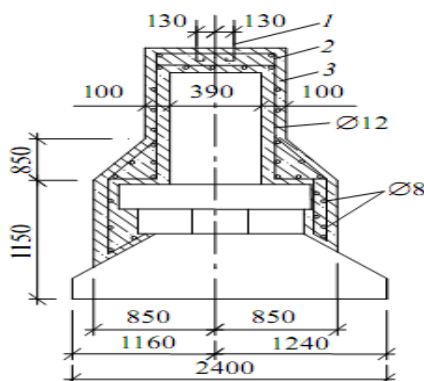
Варіант посилення залізобетонної обоймою збірного окремого фундаменту:
